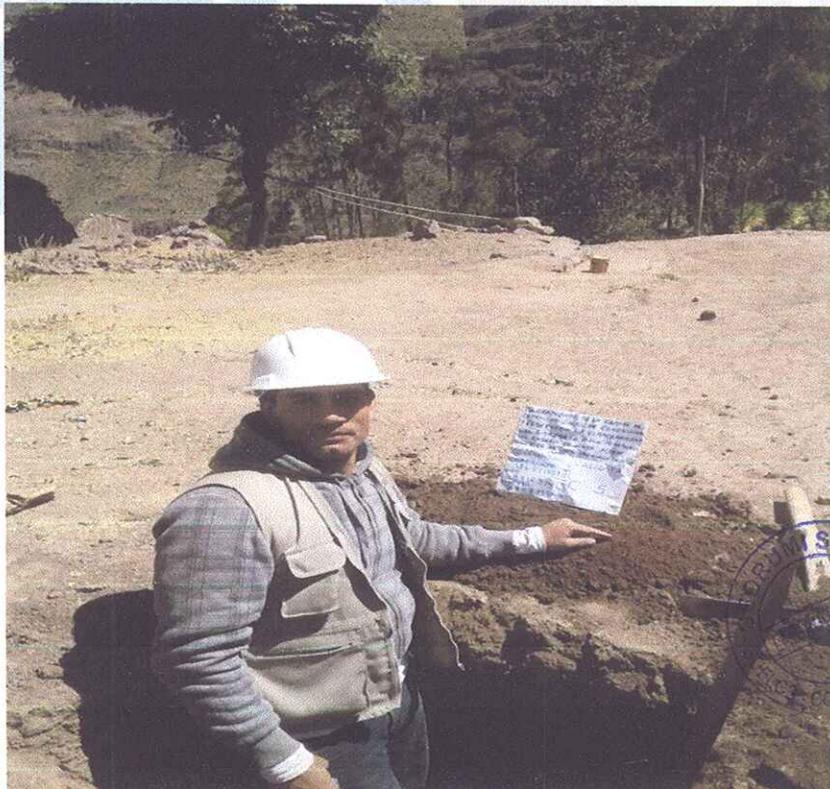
Se aprecia en detalle una vista panorámica de la calicata C-05.
